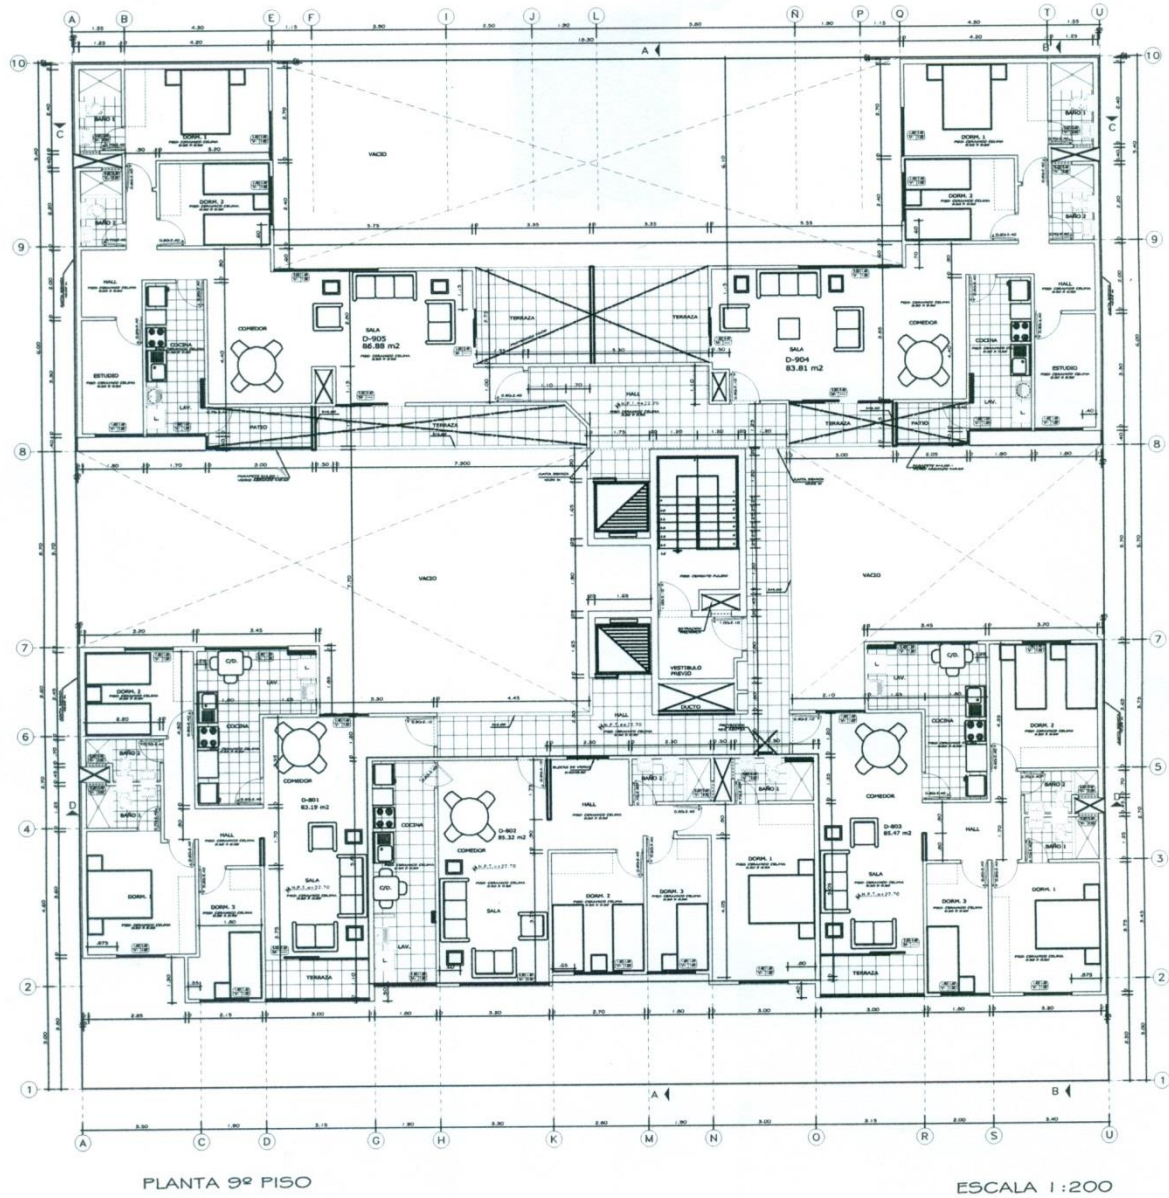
Plano de planta del noveno piso del proyecto Edificio Asturias
